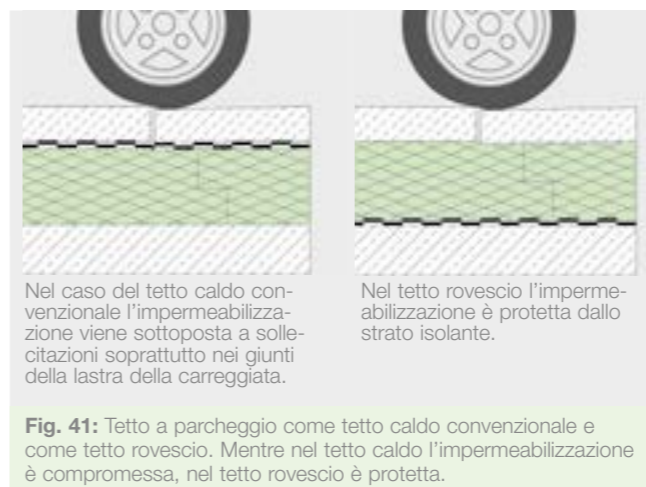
Tetto a parcheggio come tetto caldo convenzionale e come tetto rovescio. Mentre nel tetto caldo l'impermeabilizzazione è compromessa, nel tetto rovescio è protetta.
